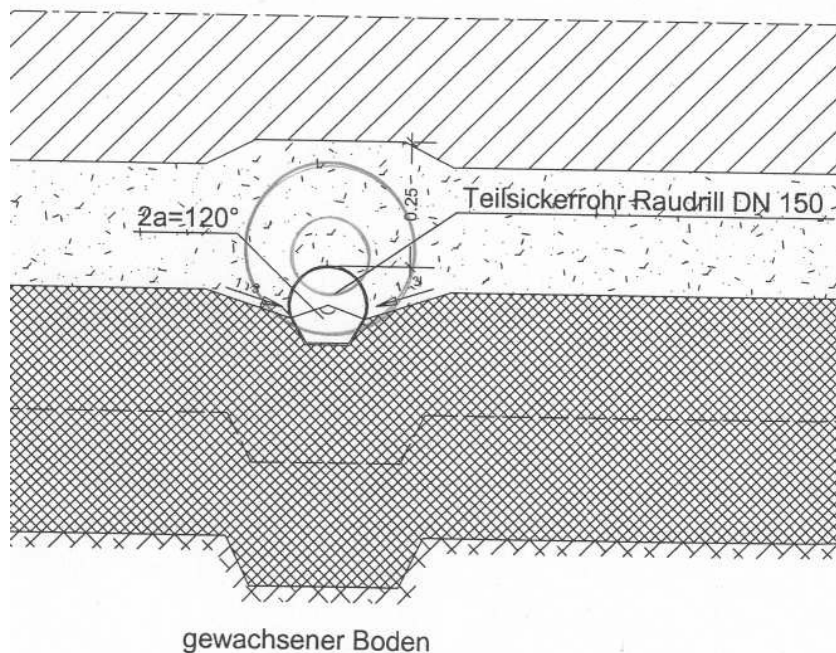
Deponie Walleshausen - Systemskizze Überschnitt
